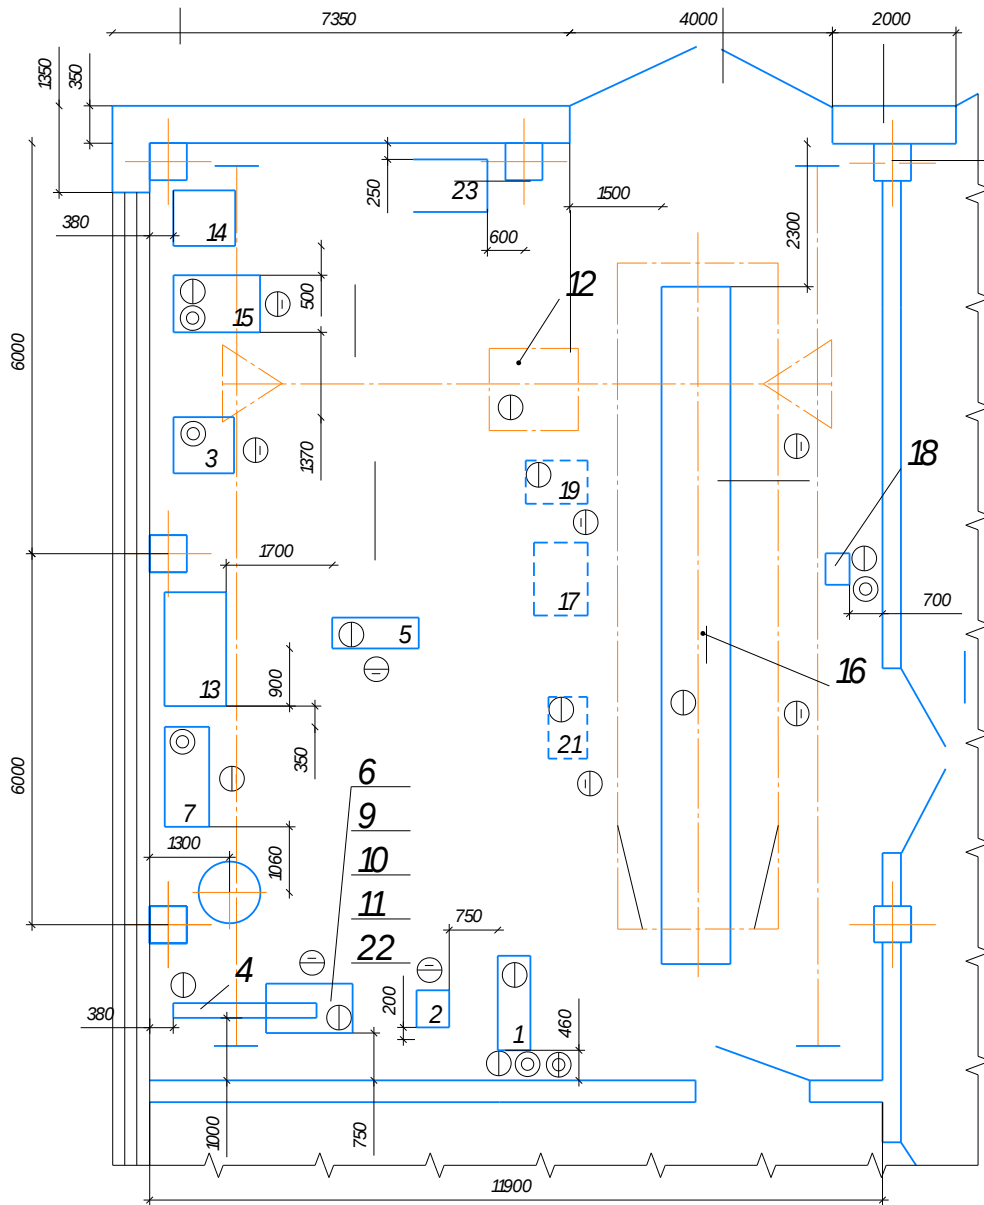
Планування шинної дільниці: 1 - мікропроцесорний верстат для балансування коліс; 2 - верстат точільно-шліфувальний; 3 - спредер з пневмопідіймачем; 4 - привід шерохувального інструменту з гнучким валом; 5 - прес гідравлічний; 6 - верстак для ремонту шин; 7 - установка для перевірки камер коліс; 8 - вішалка для камер; 9 - клеємішалка настільна; 10 – вологомір; 11 - набір інструмента для шиноремонтника; 12 - таль електрична; 13 - стелаж для автомобільних коліс; 14 - стелаж для дисків коліс; 15 - стенд для демонтажу шин; 16 - напільний підіймач; 17 - візок для зняття коліс; 18 - колонка повітряроздавальна; 19 - гайковерт для гайок коліс; 20 - страхуюче пристосування при підкачуванні шин на автомобілі; 21 - установка для балансування коліс без їхнього зняття; 22 - електронний металошукач; 23 - скриня для відходів.
